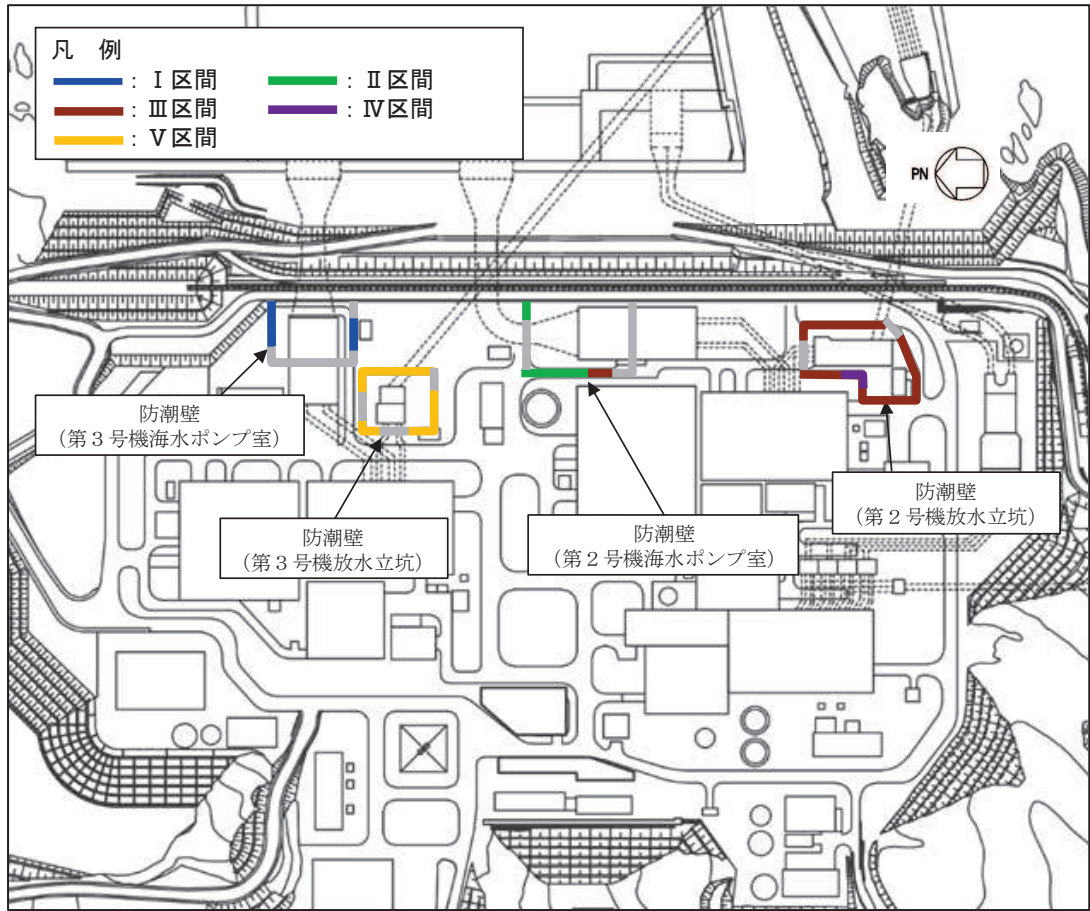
鋼製遮水壁（鋼板）の区間配置図
